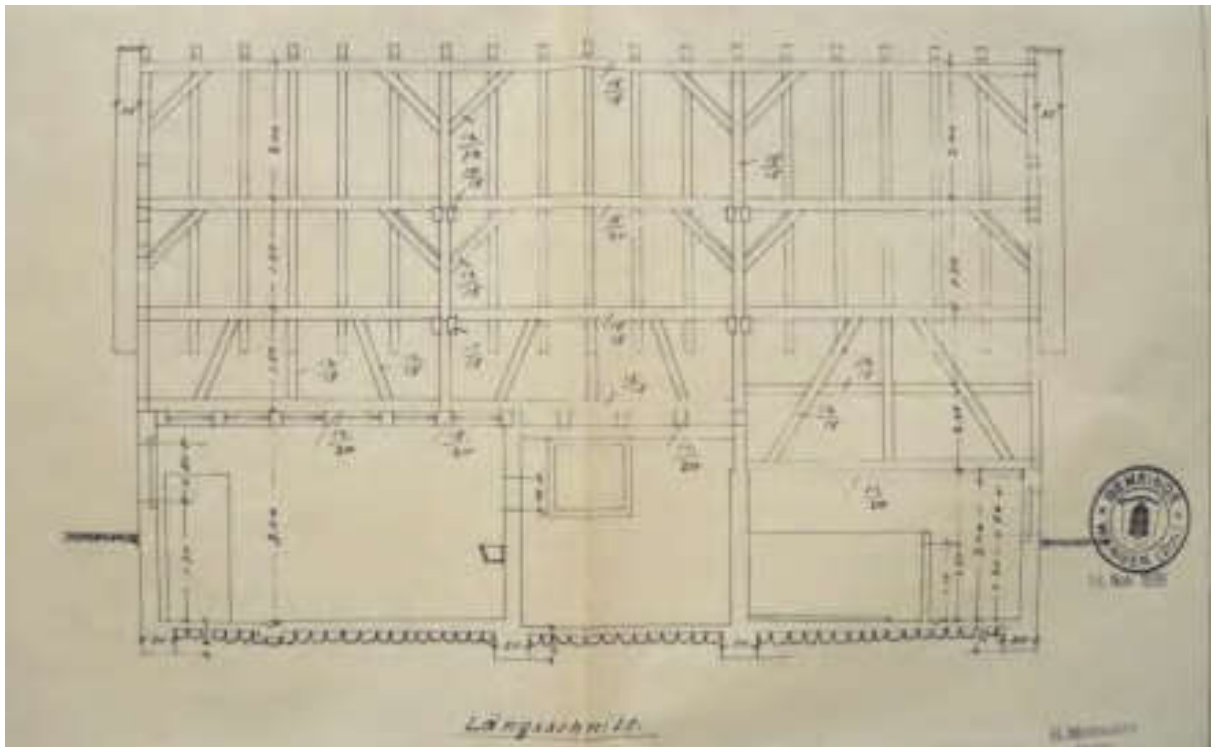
Baueingabeplan Ökonomiegebäude Assek.-Nr. 350, Längsschnitt 1:50, 25.09.1939, Markwalder Baubüro. Quelle: GdeA.
